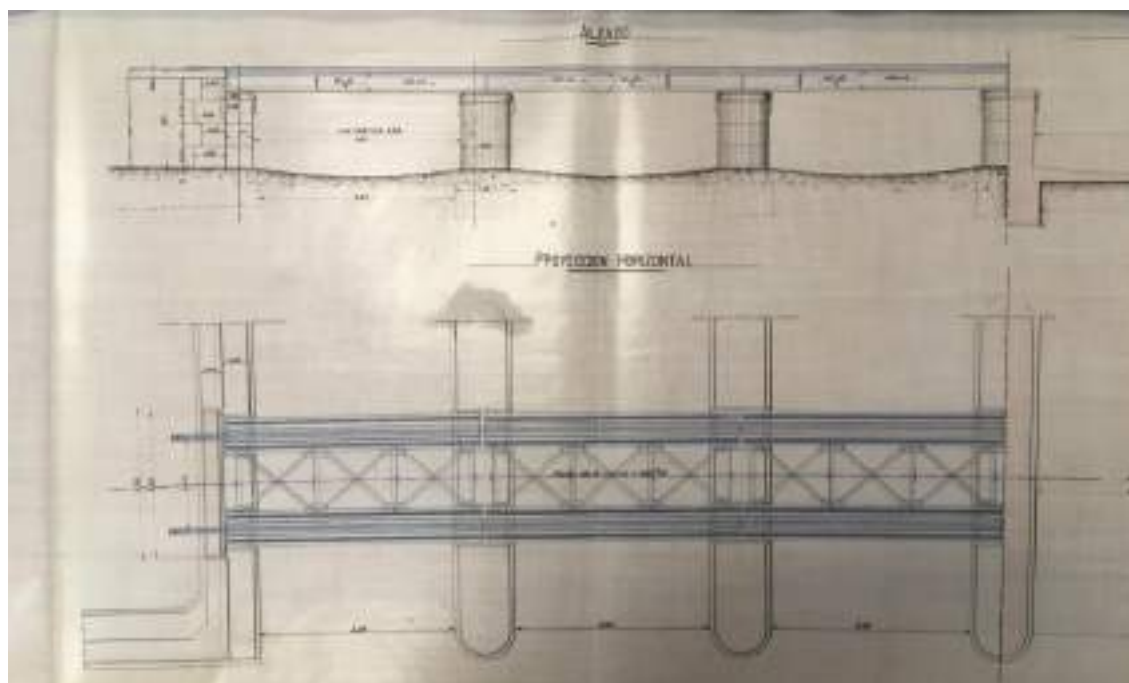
Alzado y Proyección horizontal de los planos para la construcción de 5 claros de 4 metros de luz con tramos metálicos, 1905, en "Proyecto de ejecución, Obra de 5 claros de 4 metros de luz con tramos metálicos". AHF-MFM. signatura B-0057-006-3:16.
